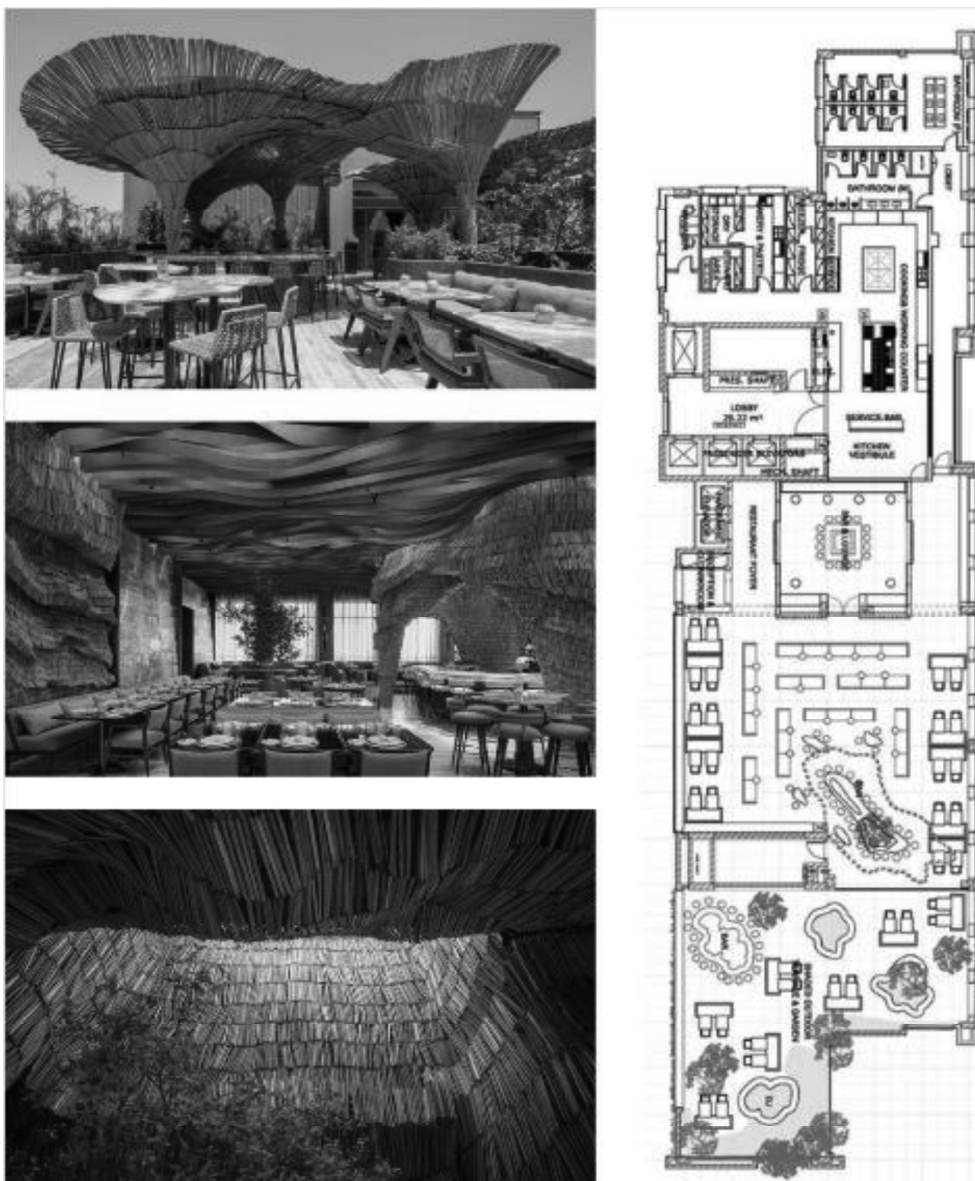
Lucinda Restaurante and Bar - Fonte: ArchDaily (Nour El Refai, Farida Bustani, 2024)
